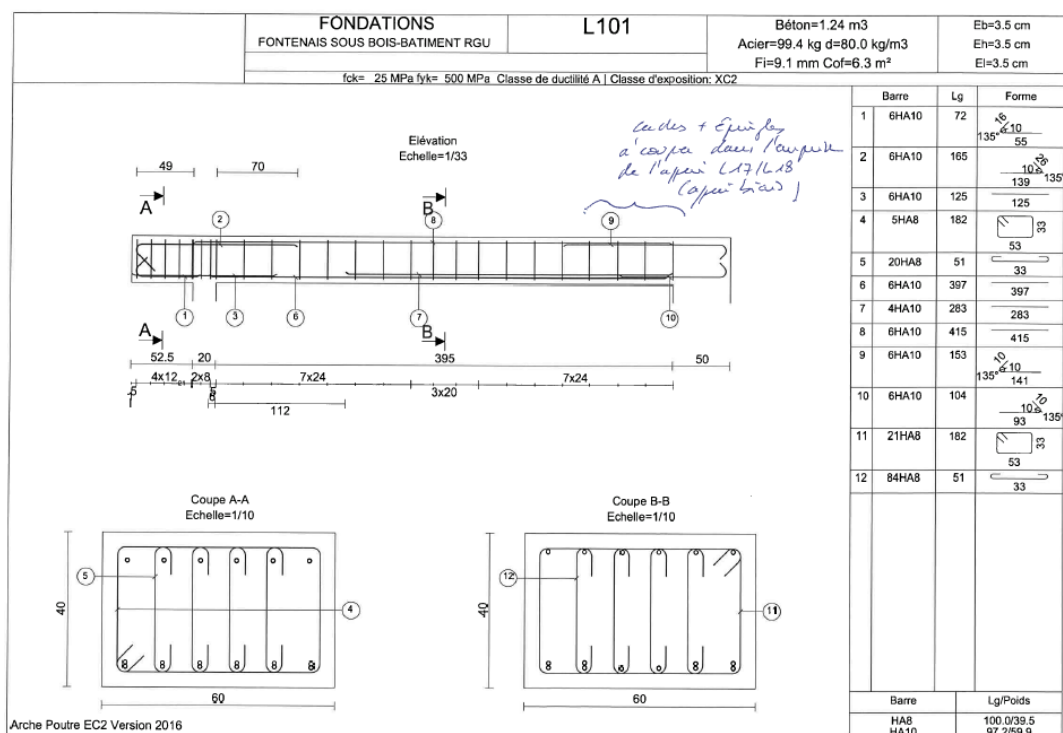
Plan de ferrailage de la longrine // © SOGEA
